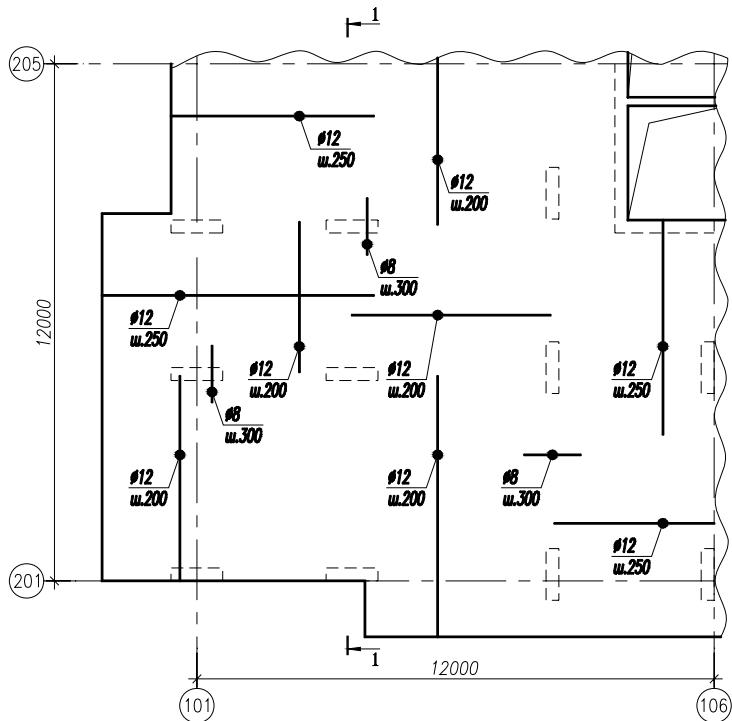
Фрагмент нижнего армирования плиты перекрытия
